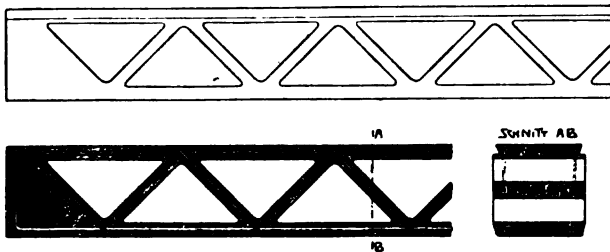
bis 389. Ansicht, Längen- und Querschnitt eines Eisenbetongitterträgers, System Visintini.
